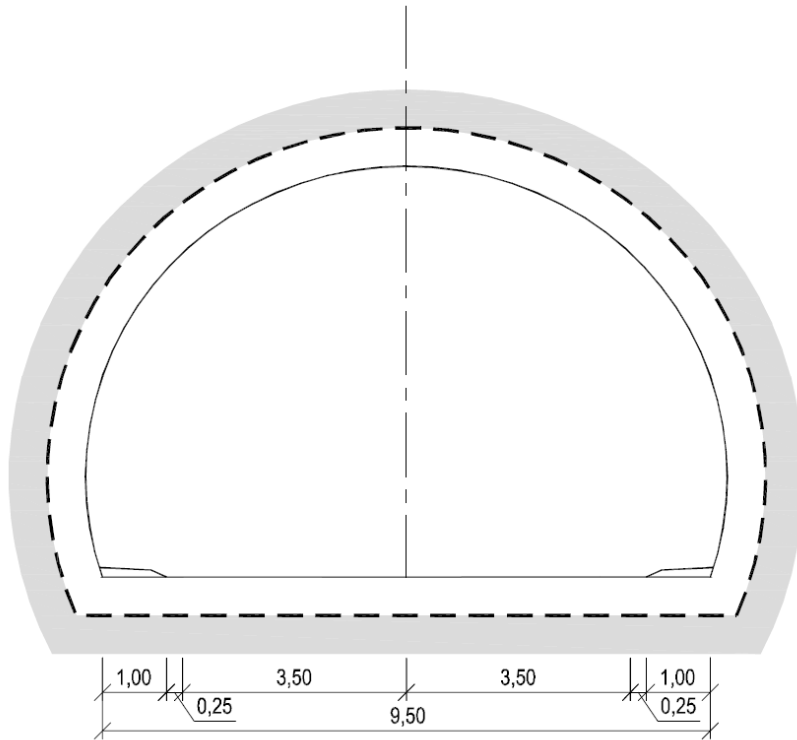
Tunnelprofil T8,5 (mål i m).
